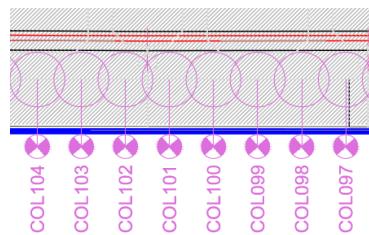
Vue en plan du maillage d'implantation des colonnes de jet grouting en pied de quai
